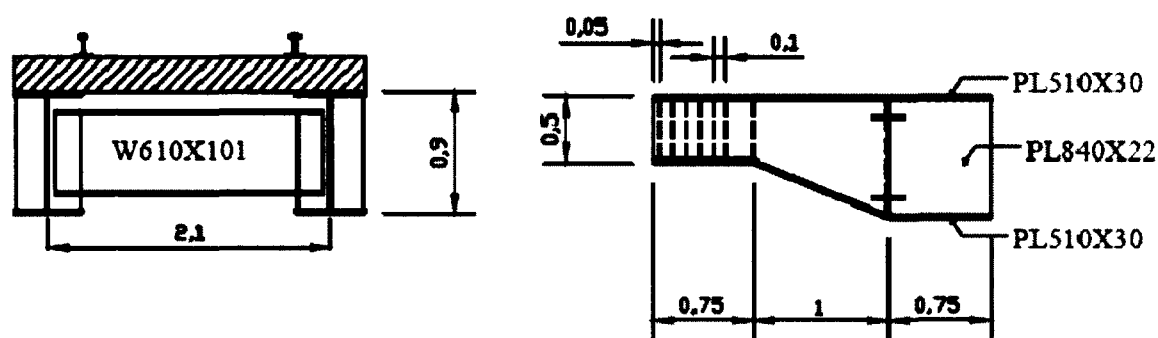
Pont bi-poutres - Section transversale et élévation - Section A
